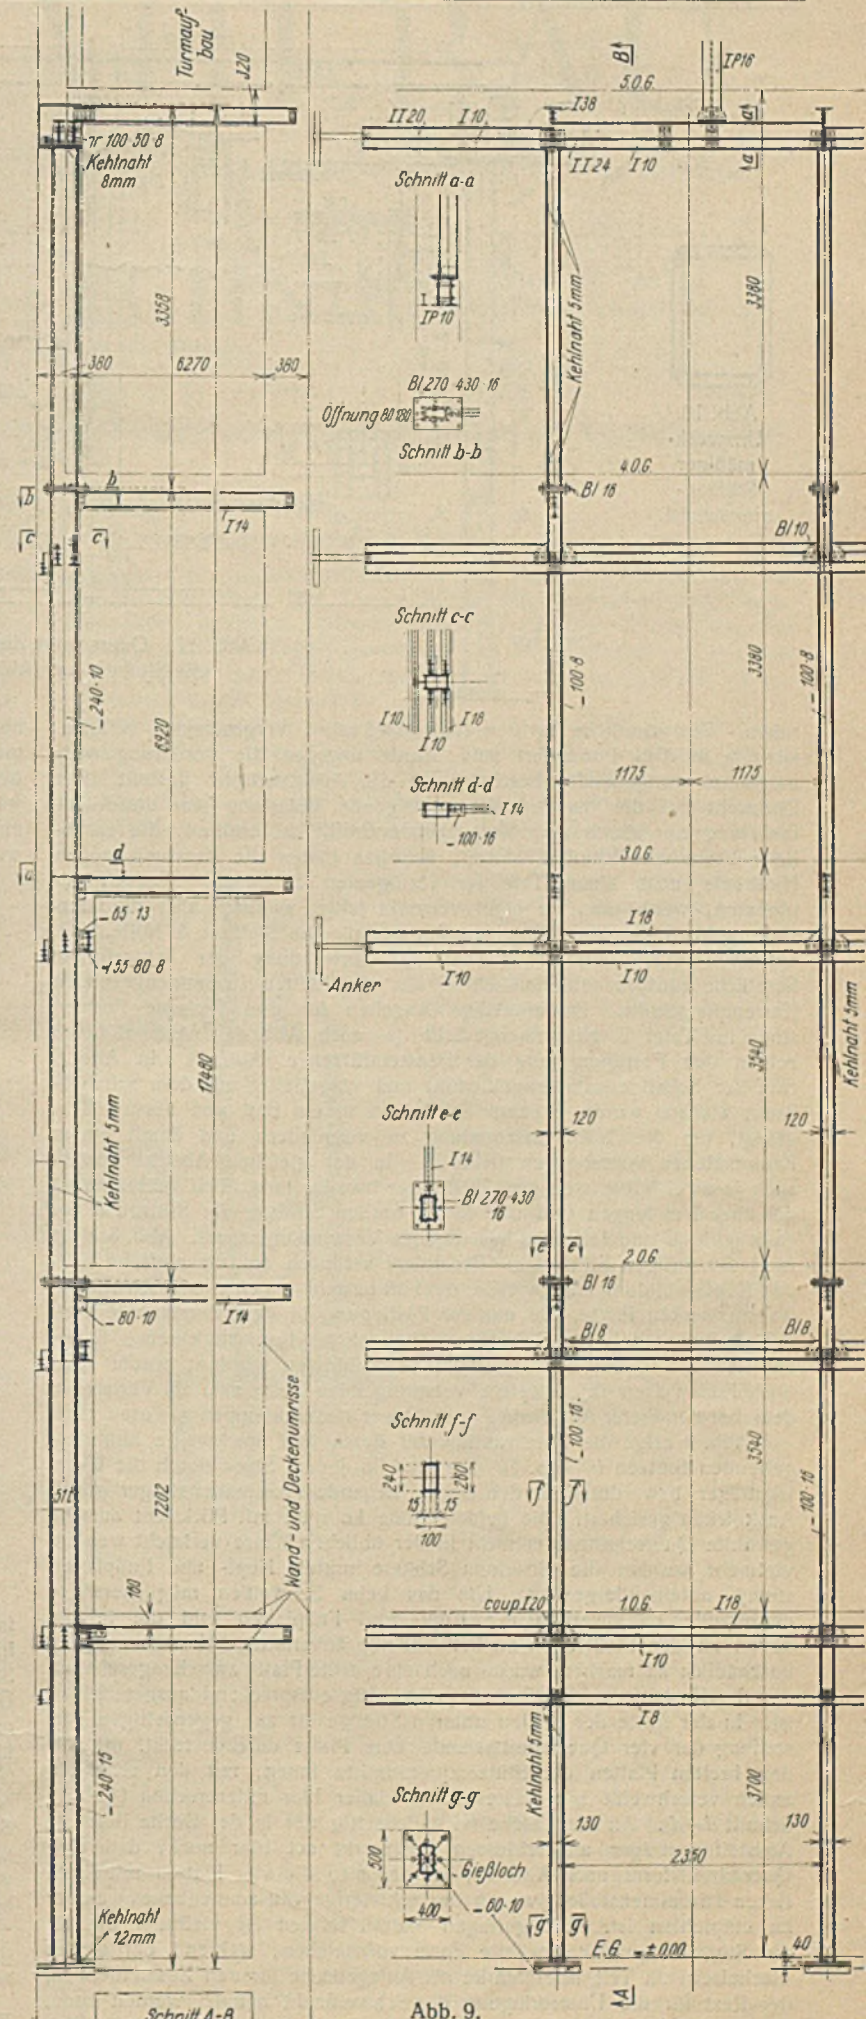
Konstruktive Durchbildung der Stützen „b“ mit Anschluß der Deckenträger. Das Bild veranschaulicht in demonstrativer Weise die Schlankheit der geschweißten Stützen.
